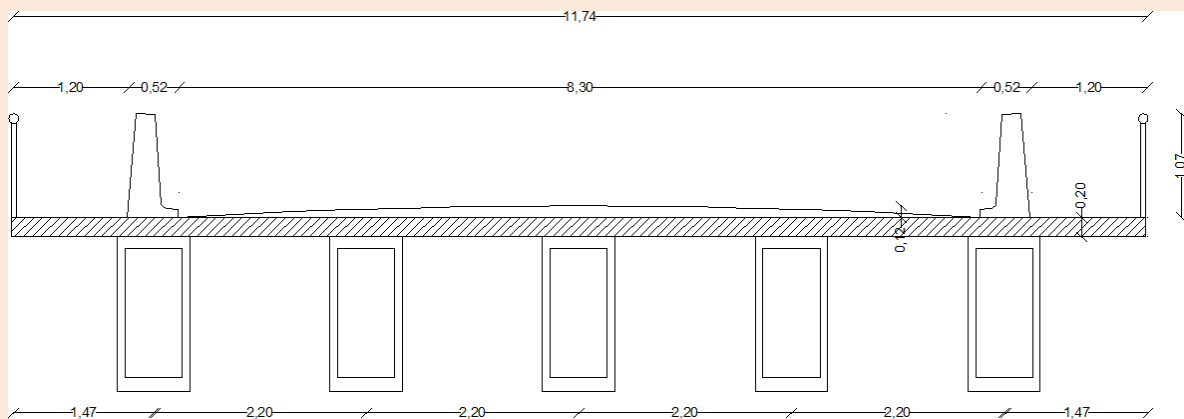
Superestructura, donde se aprecia el tablero y las Vigas principales.
